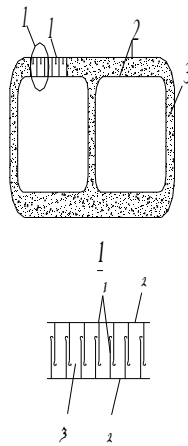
Поперечний переріз тунельної сталобетонної конструкції: 1 – з'єднувальні стрижні; 2 – стальова оболонка; 3 – монолітний бетон.
